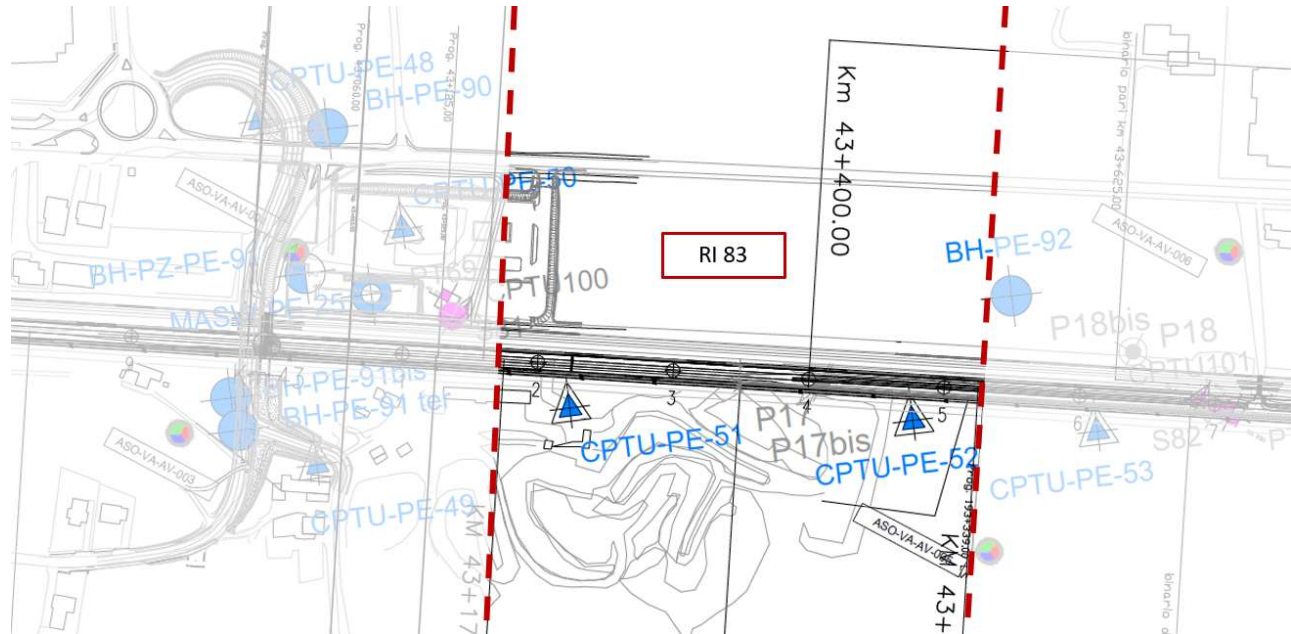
Planimetria Rilevato RI83, estratto dalla Planimetria Generale (Doc. Rif. [3])
